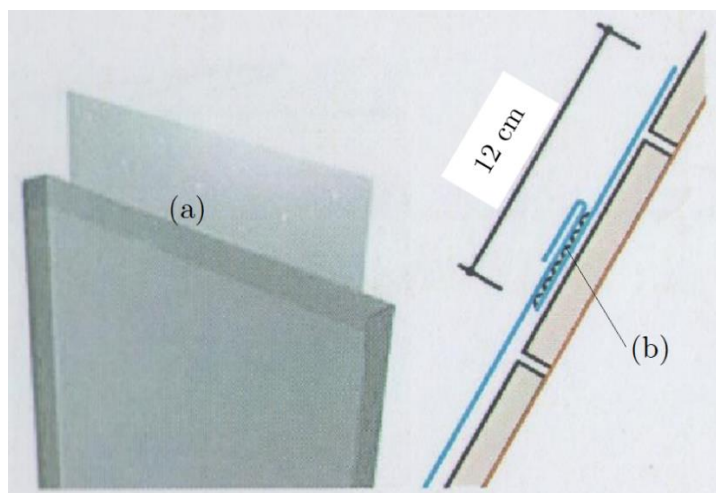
Fixação das placas de revestimento por soldadura, (a) - Chapa ou perfil de fixação de primeira fiada, (b) - soldadura ou aparafusamento
